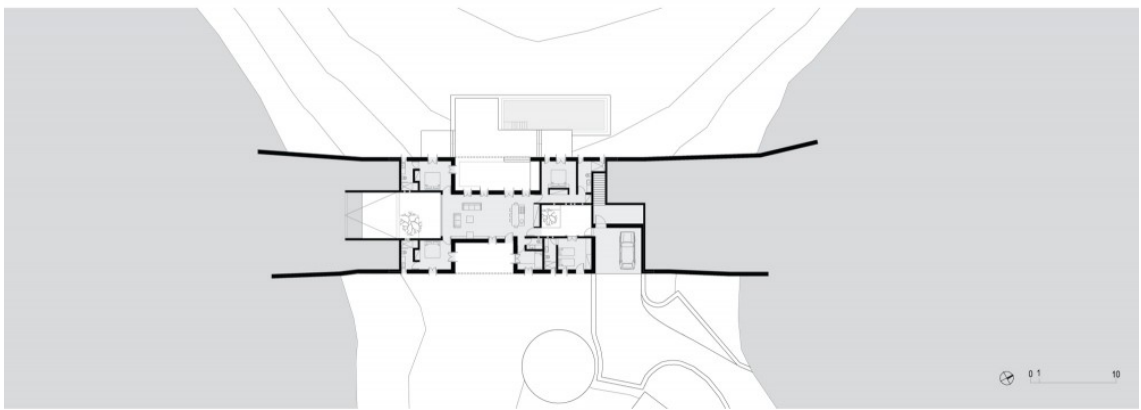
| GRUNDRISS
